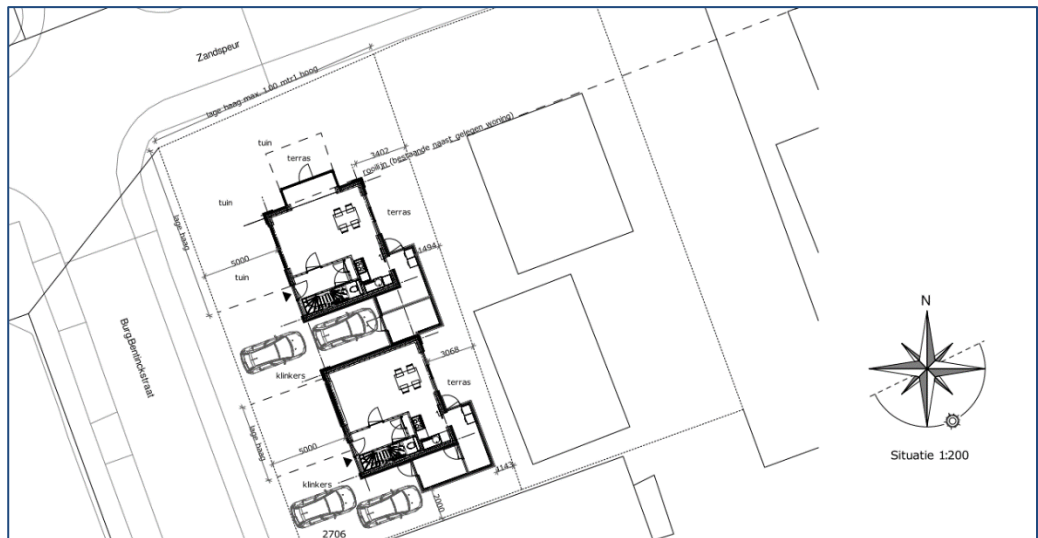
Een weergave van de beoogde situering van de twee woonblokken en inrichting in het plangebied (bron tekeningen Van Dijk Ontwerp en Engineering)
